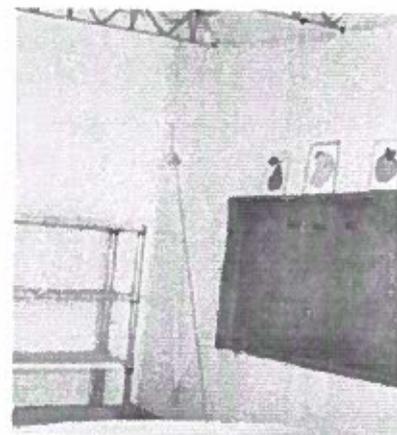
y 09: Vista comedor, se observa fisura en muro
